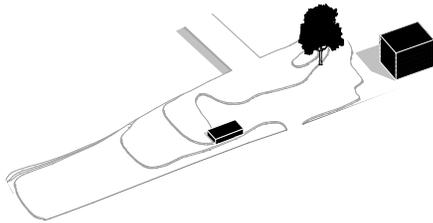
Vertiefungsvariante Reusspark, Blick von der Kirchenterrasse
